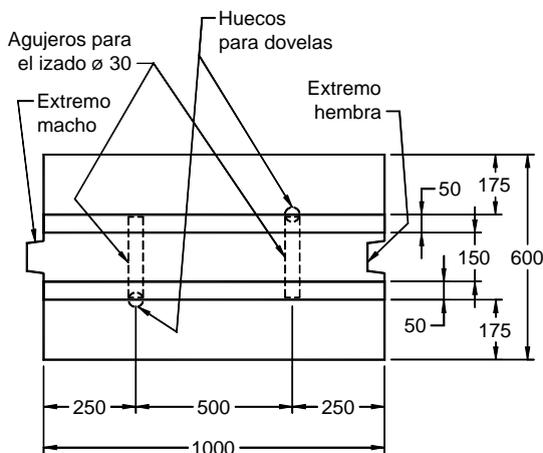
Perfil de una barrera de seguridad de concreto, según su aplicación en la vía
